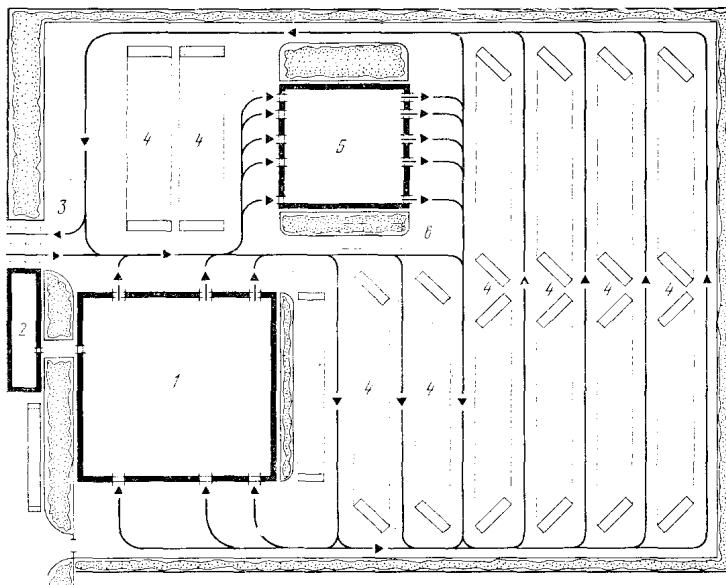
Генеральний план вантажного АТП на 250 автомобілів КАМАЗ. 1 – головний корпус; 2 – адміністративно-побутовий корпус; 3 – КПП; 4 – стоянки автопоїздів; 5 – допоміжний корпус; очисні споруди
